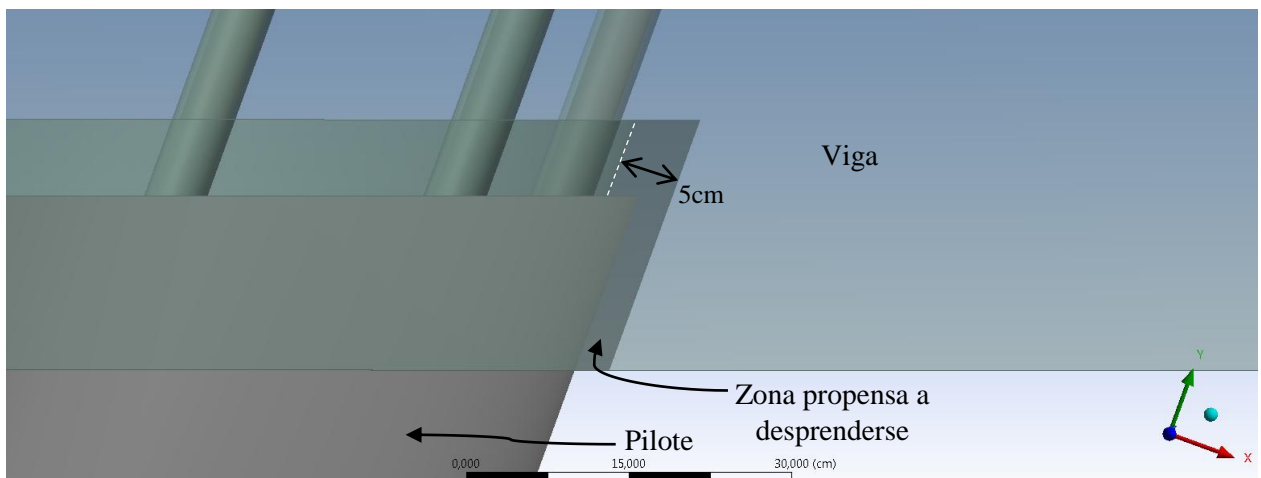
Detalle de la zona de intrusión del pilote inclinado en la viga de hormigón armado.
